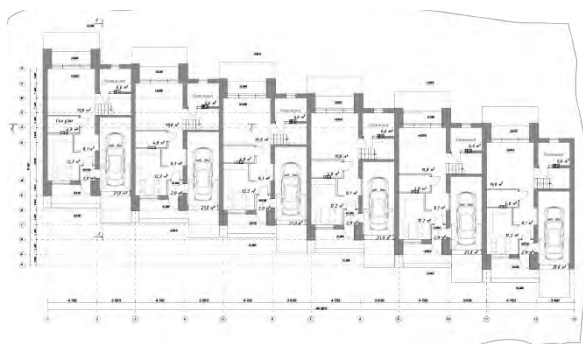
План 1 этажа проект таунхауса от компании House Expert [7]
